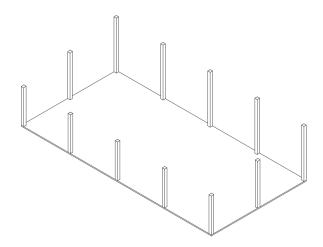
Axonometría estructural tipo 1_1 Fuente: Autores, 2024
